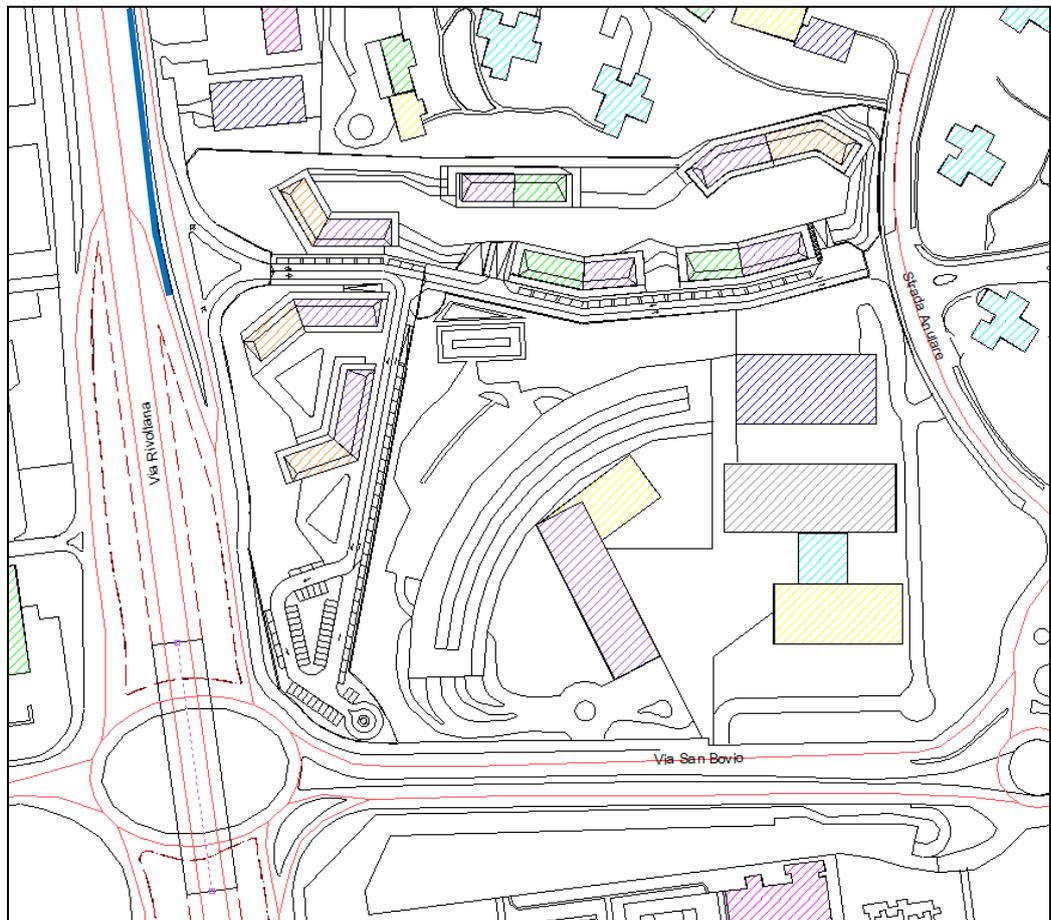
Planimetria con indicazione dell'altezza degli edifici allo stato di progetto
